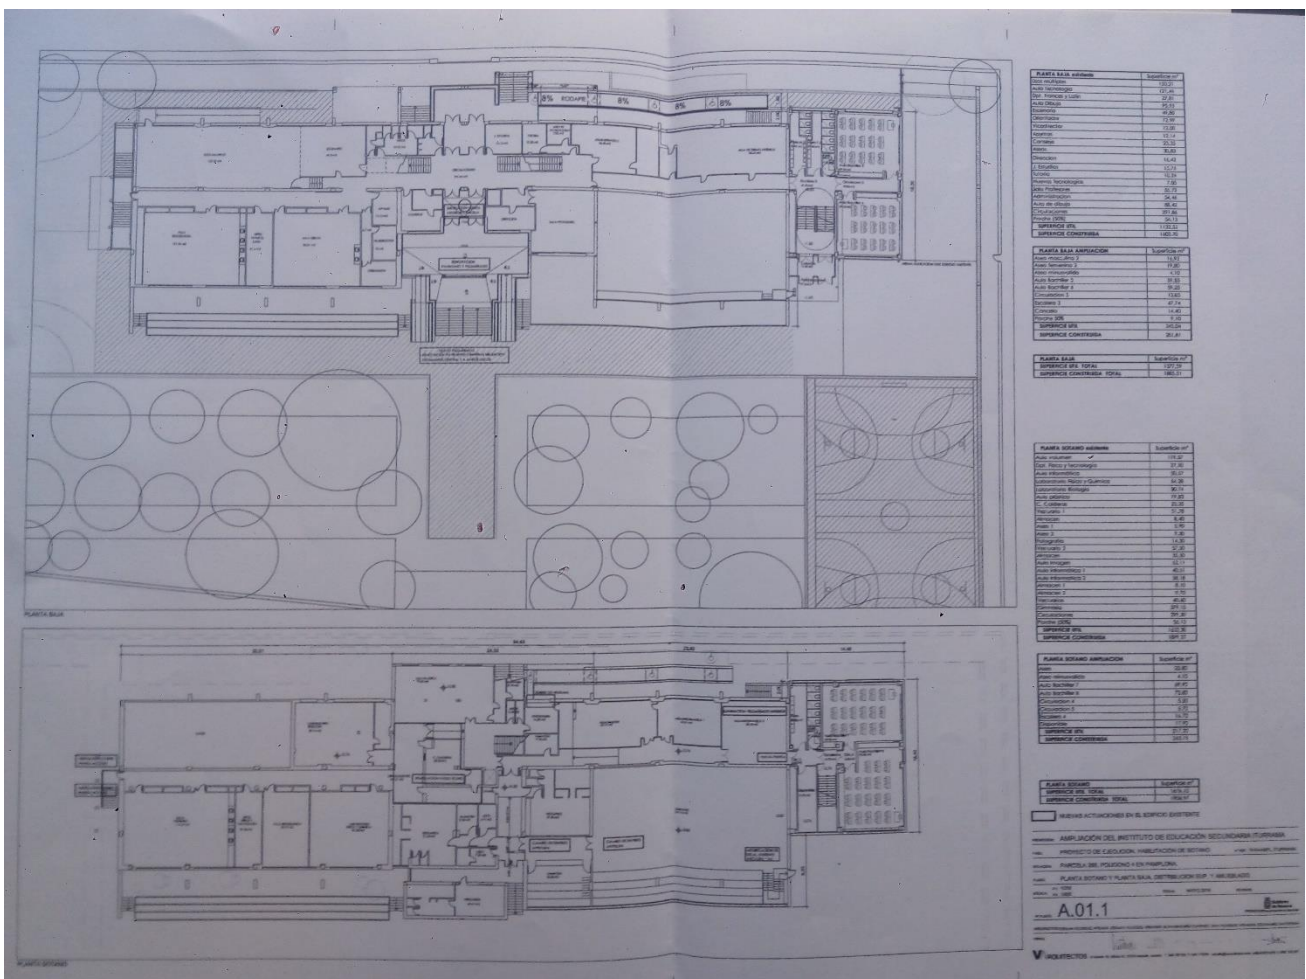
Planos de planta Iturrama BHI. Fuente: VArquitectos
